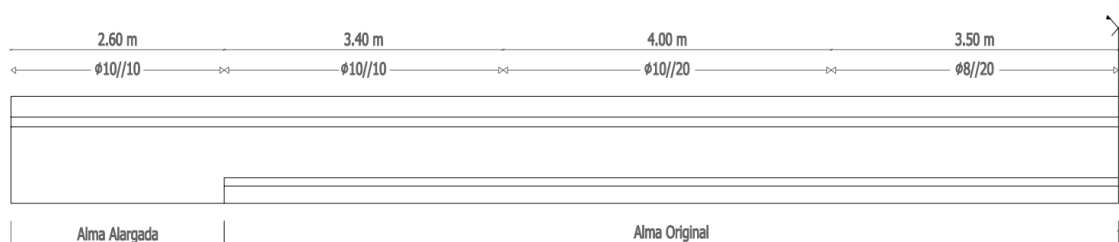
Armadura transversal da viga composta do vão central (secção longitudinal da viga).
